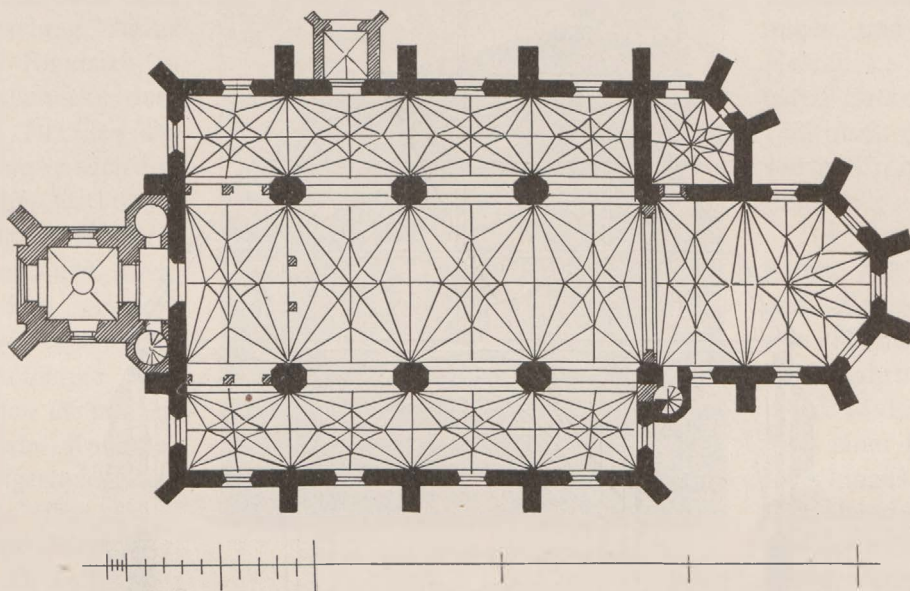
Grundriß der Kirche zu Pestlin. M. 1 : 400.
